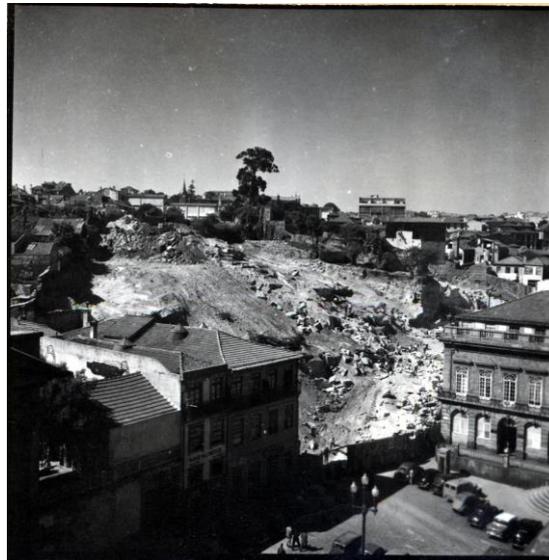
Demolição de ilhas na Rua do Cimo da Trindade, 1960.
